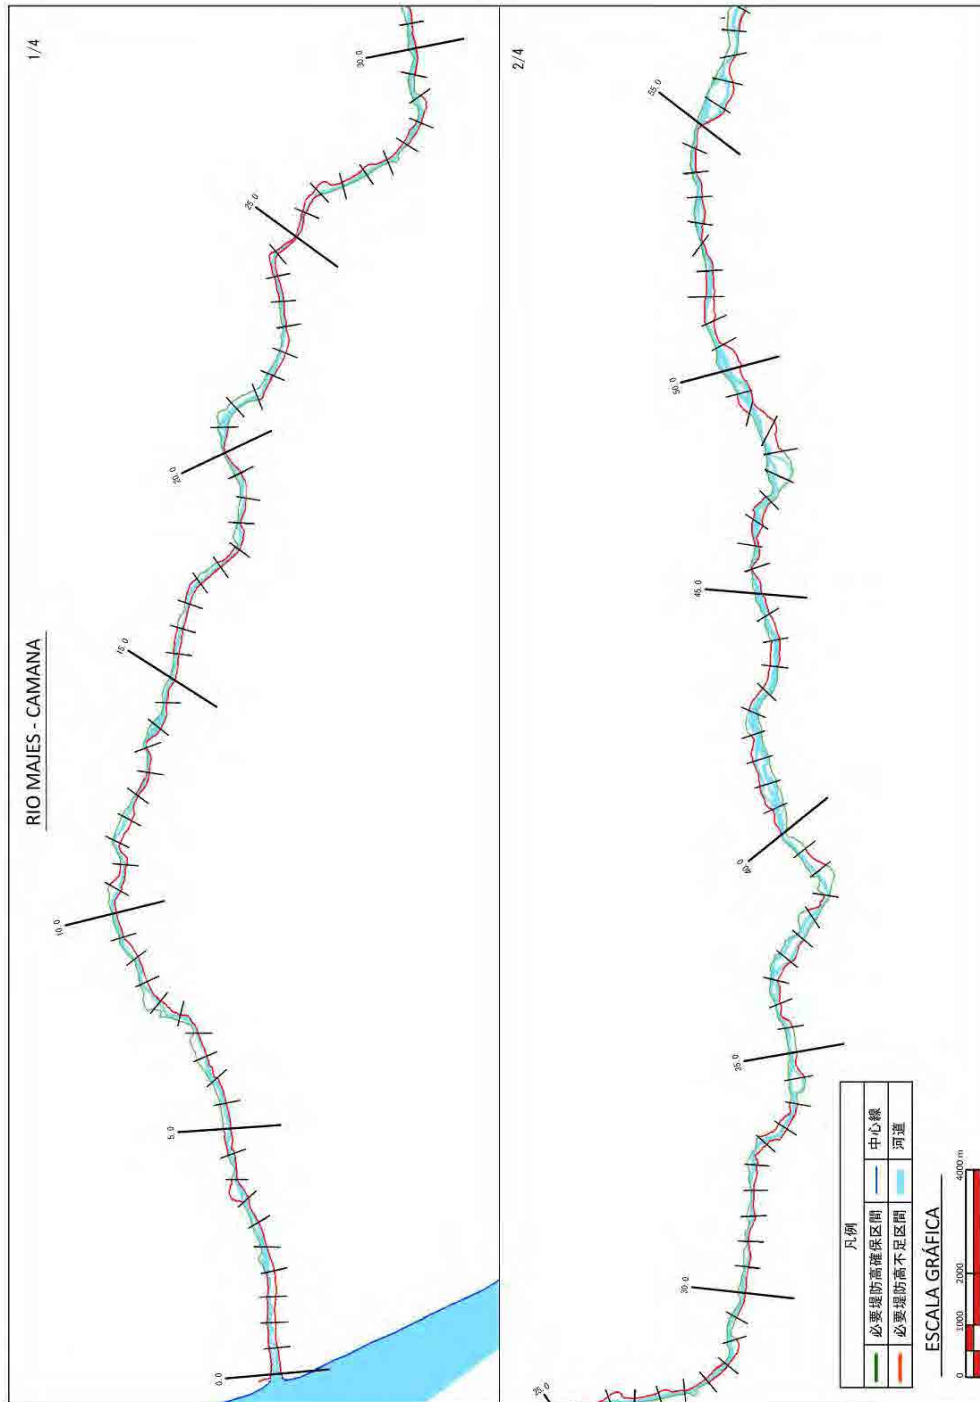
マヘスカーマナ川平面図 (0-55K)
